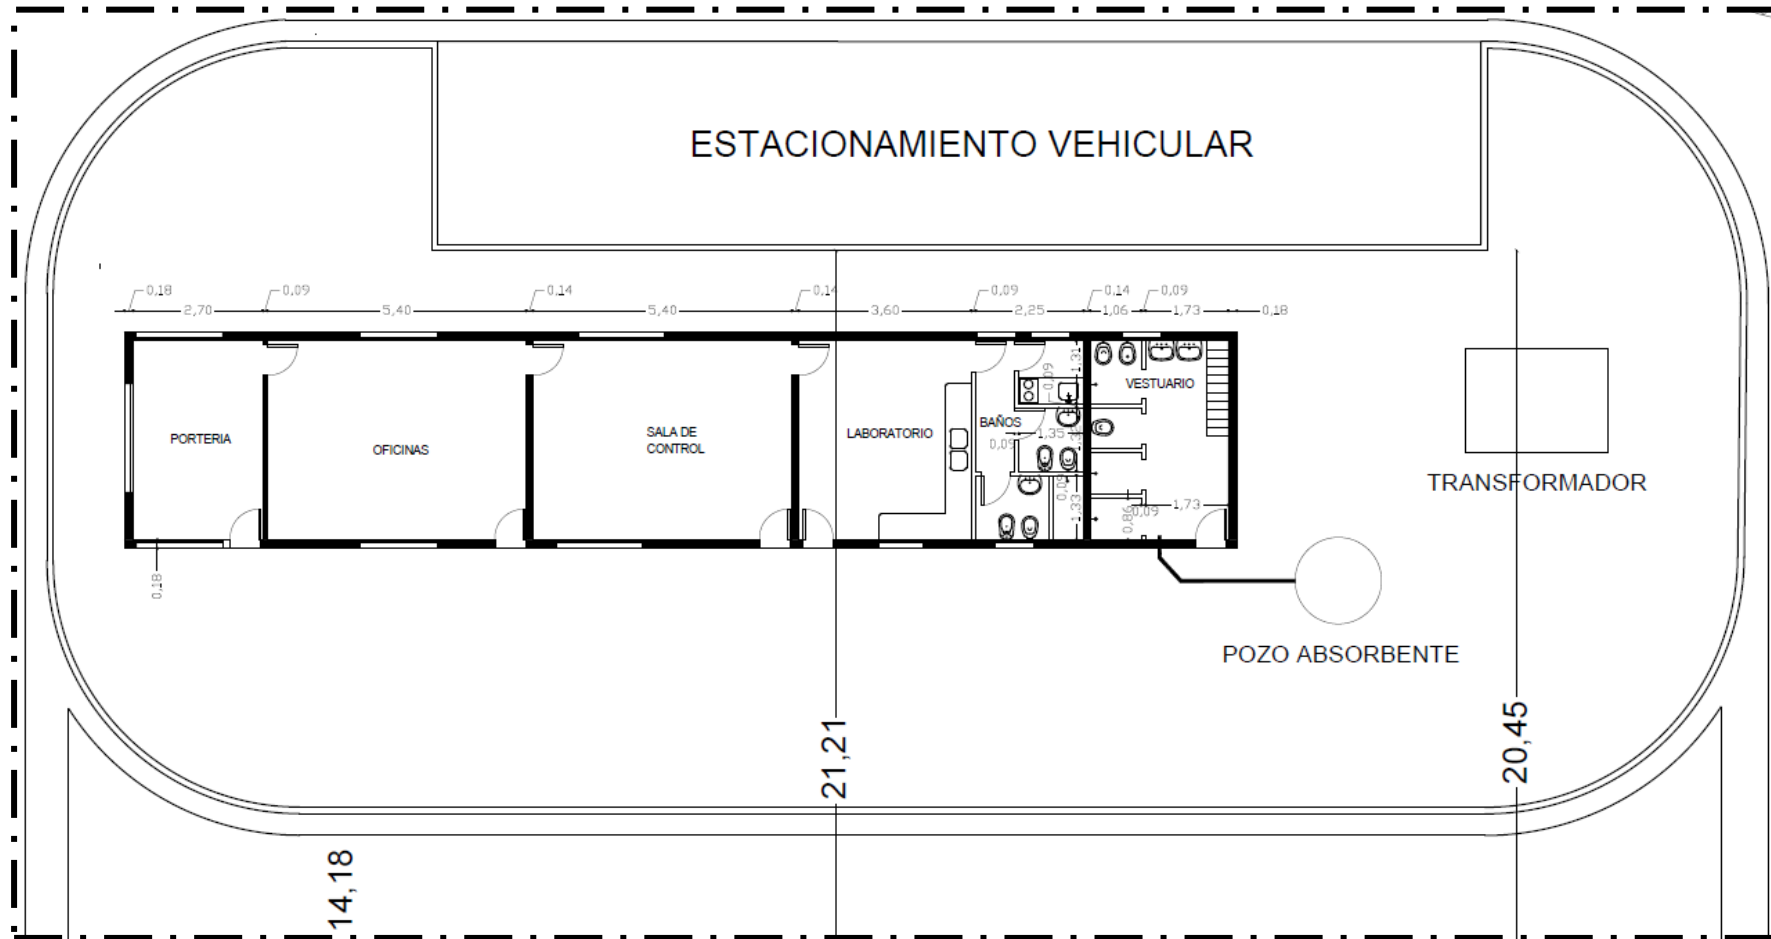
Detalle de portería, sala de control, laboratorio, baños y vestuario.
